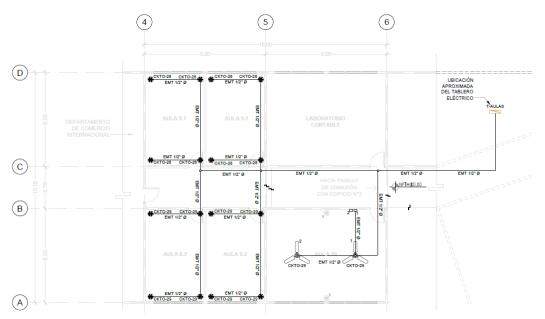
Planta de ventiladores, Primer nivel Edificio N°1
